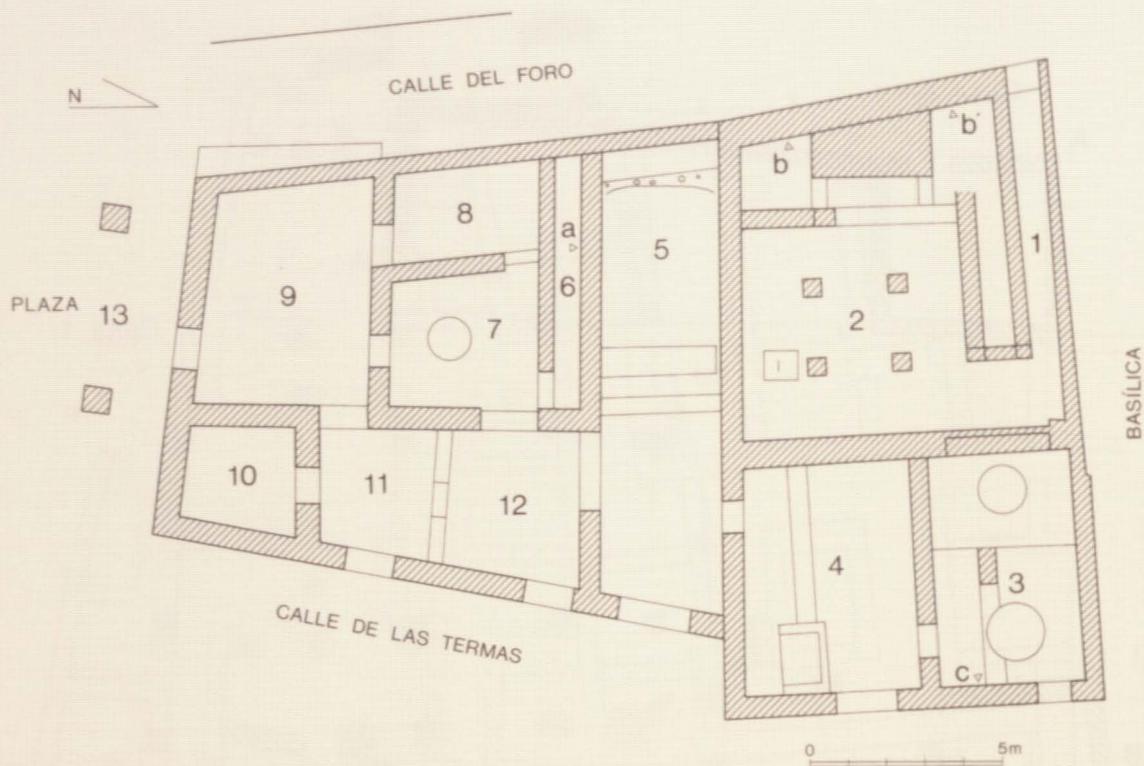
Casa 2, planta piso bajo. Las letras minúsculas a,b,c señalan la localización de los armarios. Rampa de acceso para planta baja (1); bajo con cuatro columnas y foso de *opus signinum* tallado en la roca (2); taller con prensa de aceite (3); tienda (4); gran local comercial y almacén (5); escalera (6); habitación/taller (7); habitación (8); gran vestíbulo probablemente con función de *taberna/thermopolium* y cocina/*popina* (9); cuarto (10); dos tabernas (11/12); pórtico (13).
